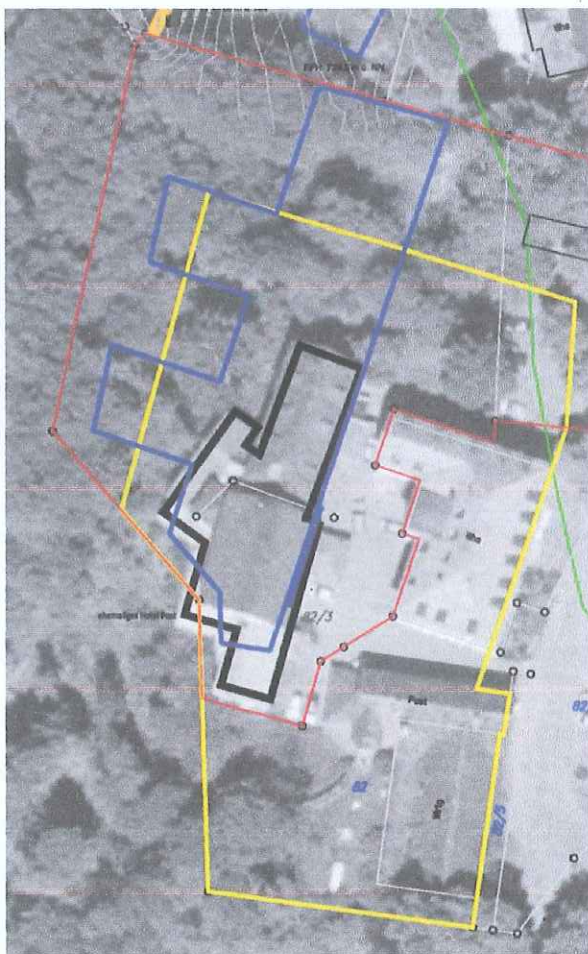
die blaue Umgrenzung stellt das geplante Baufenster, gelb das Baufenster aus dem Jahr 1968 dar
